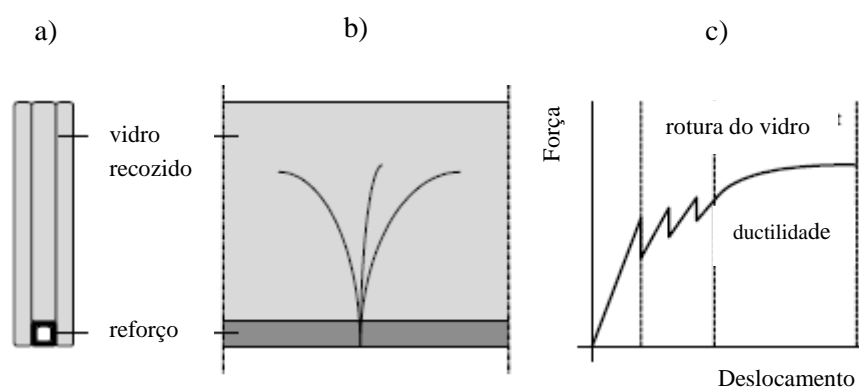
(a) Esquema da seção transversal da viga de vidro reforçada; (b) Alçado lateral de uma viga de vidro fissurada; (c) Gráfico Força-Deslocamento nos ensaios à flexão de vigas de vidro (adaptado Louter, 2011).
